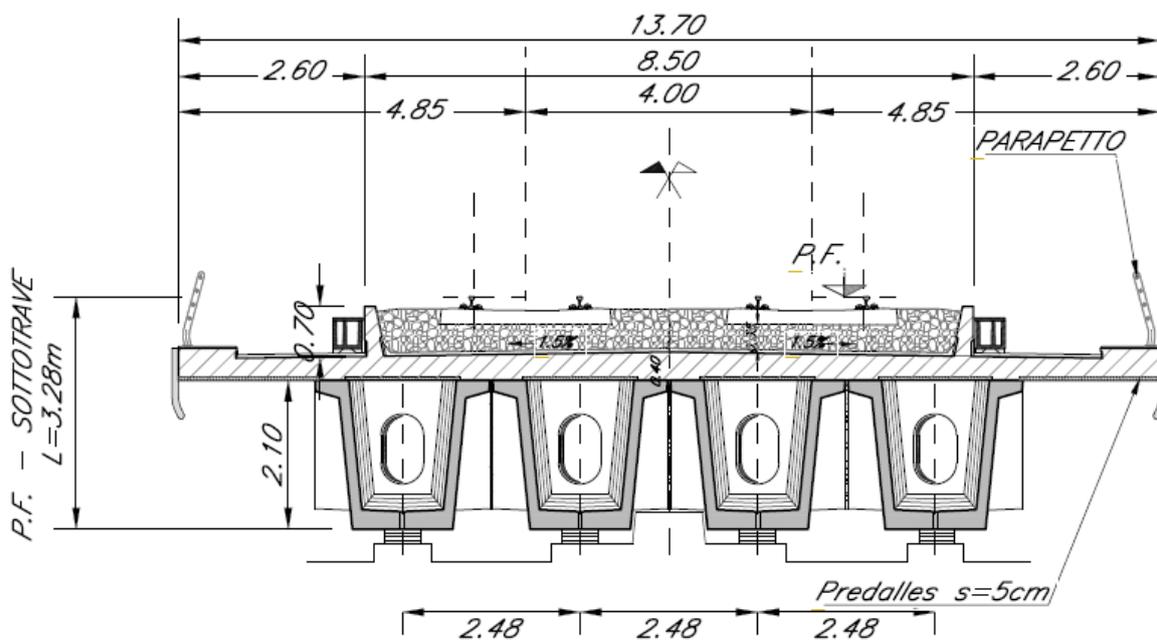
Sezione impalcato in cap da 25 m – doppio binario
